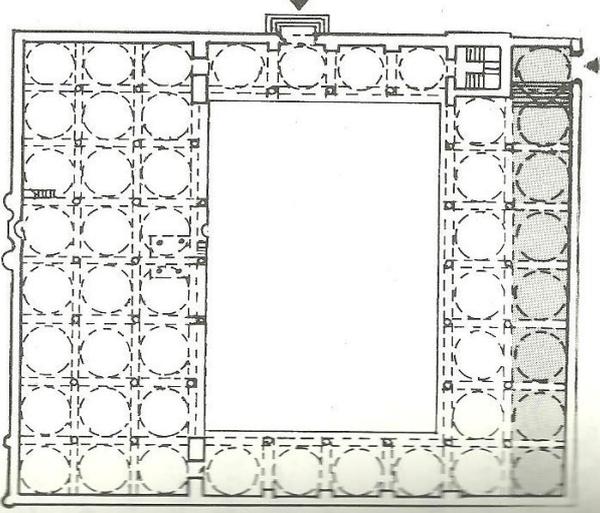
مسجد علي بن أبي طالب- مسقط أفقي
